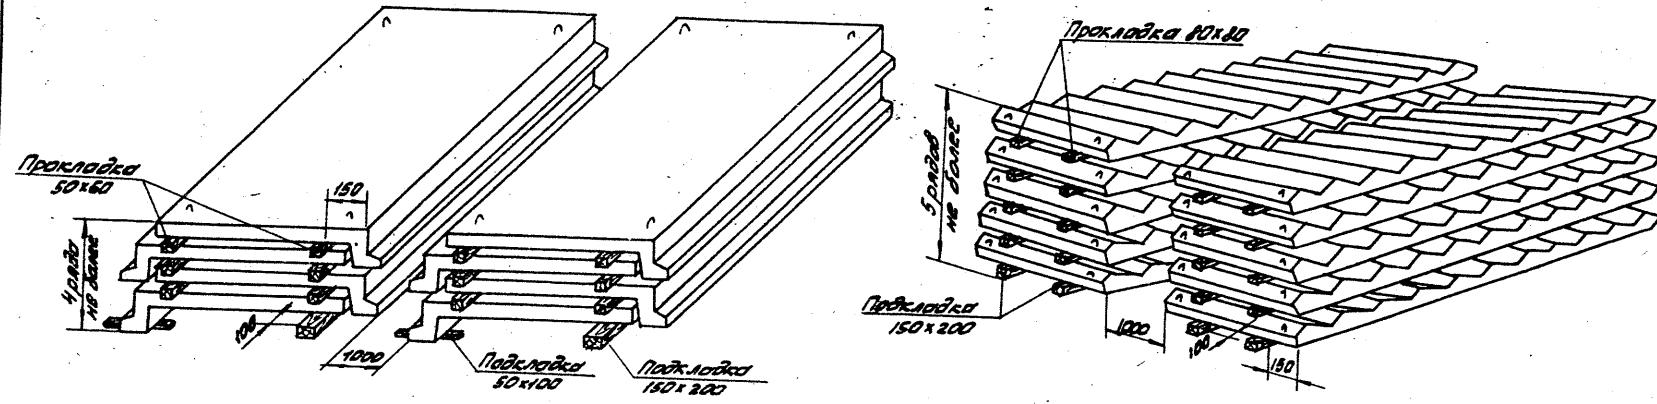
Кладорование лестничных площадок санитарно-бытовых зданий
